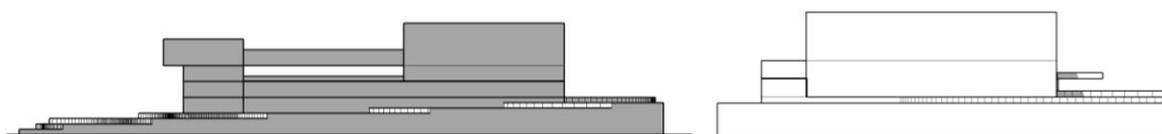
e 171: Estudo volumetrico de fachada sul e leste.
